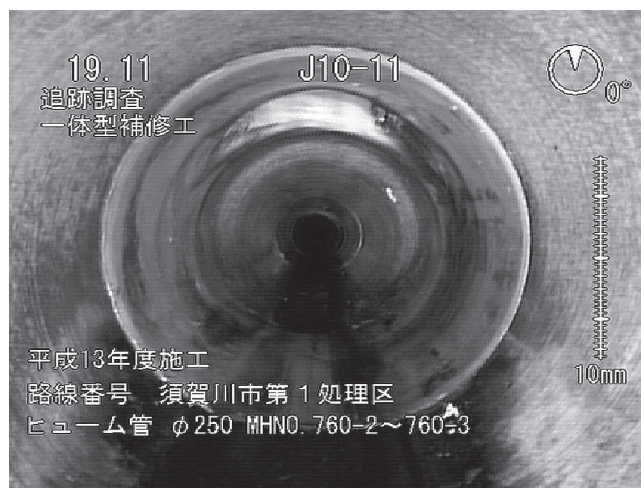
福島県 平成13年度施工 ϕ 250mm取付管接合部一体型（経年10年）
